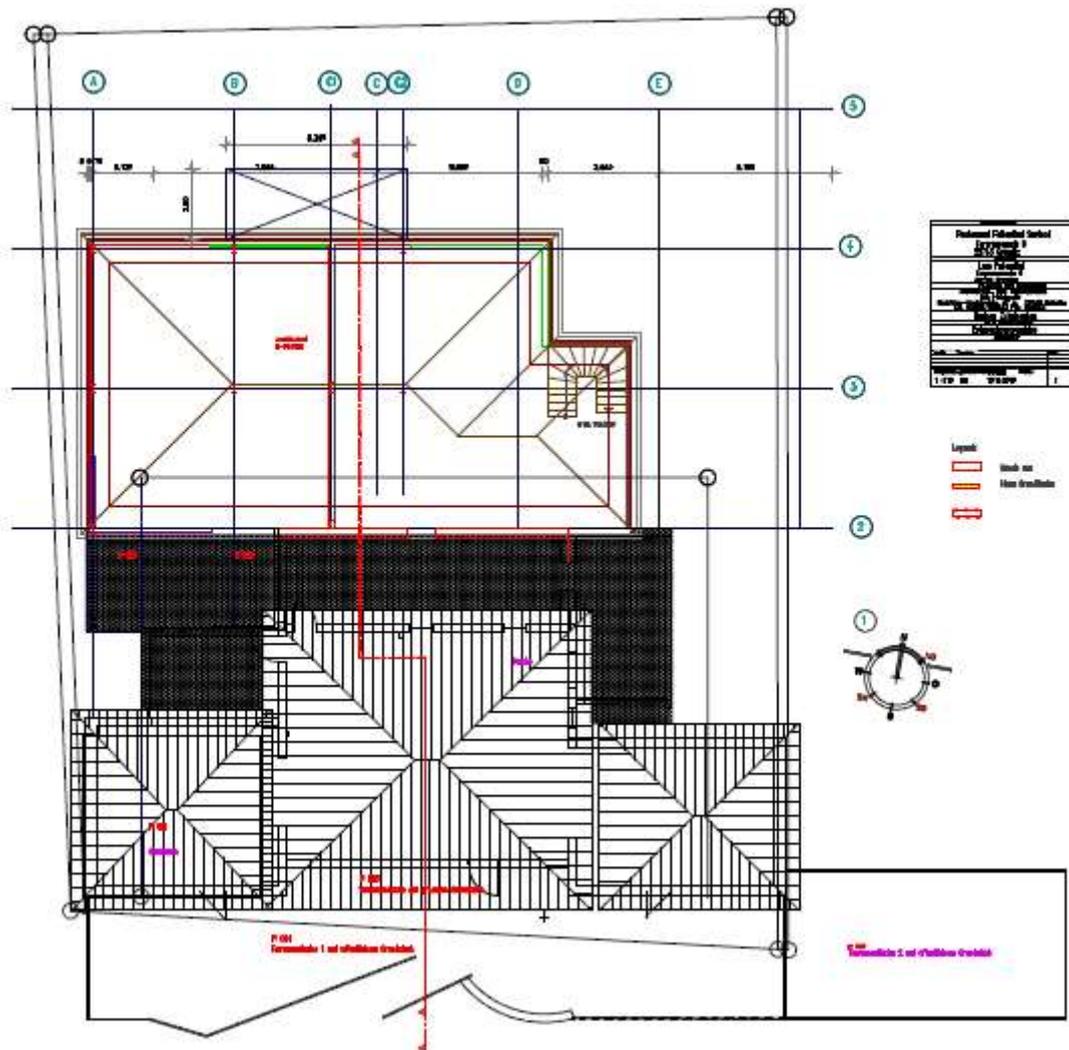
Grundriss Dachgeschoss Variante 2
